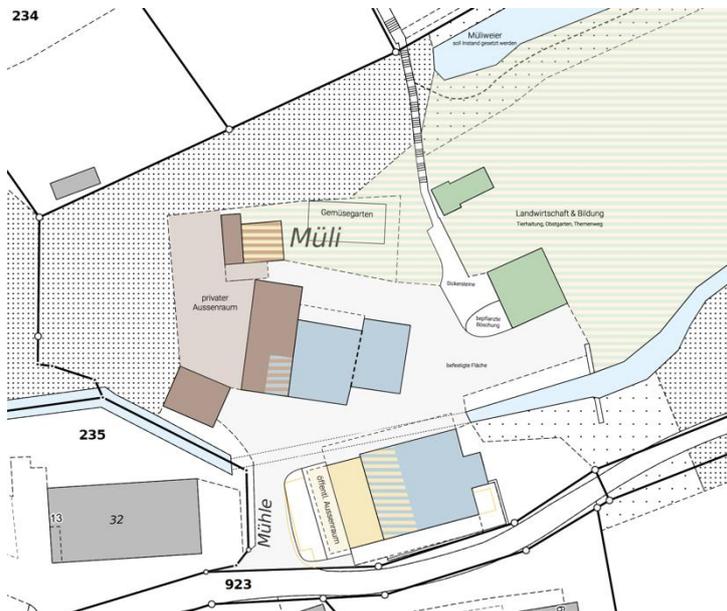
; Ausschnitt aus dem kantonalen Geoportal, Grundbuchplan 2024
